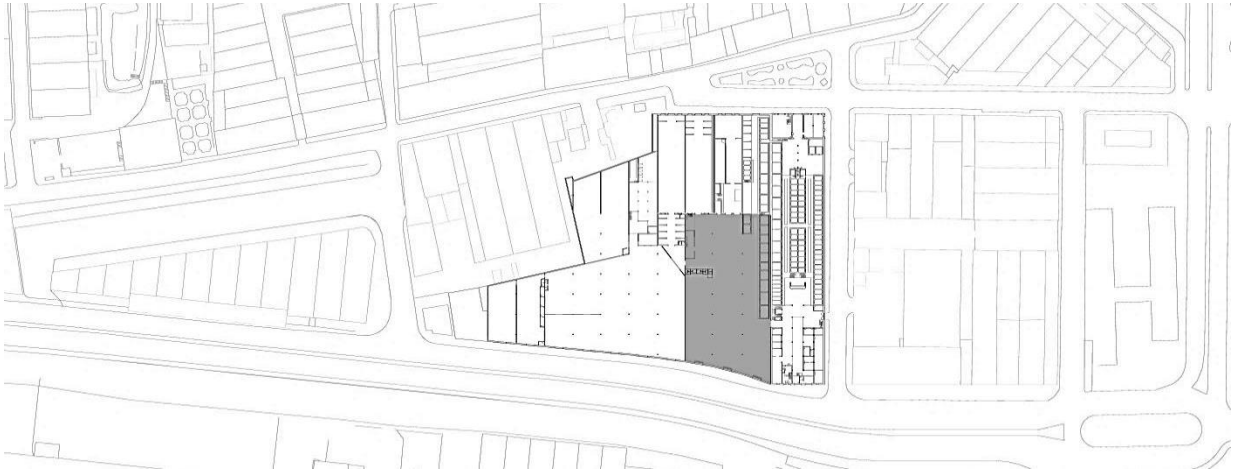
Planta de levantamento fotográfico piso térreo – Armazéns 5,7 e 9.
